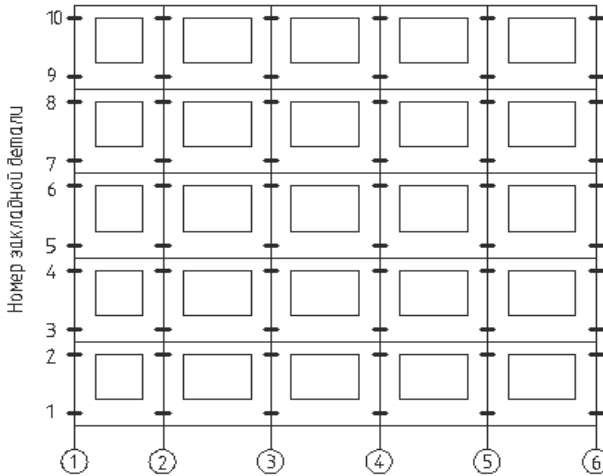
Схема фасада здания серии 1-480 с узловыми соединениями.
